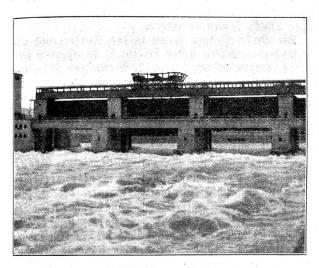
Die Wehröffnungen II/IV, anschließend das Maschinenhaus. (Aufnahme vom Schweizeruser aus, flußauswärts).
